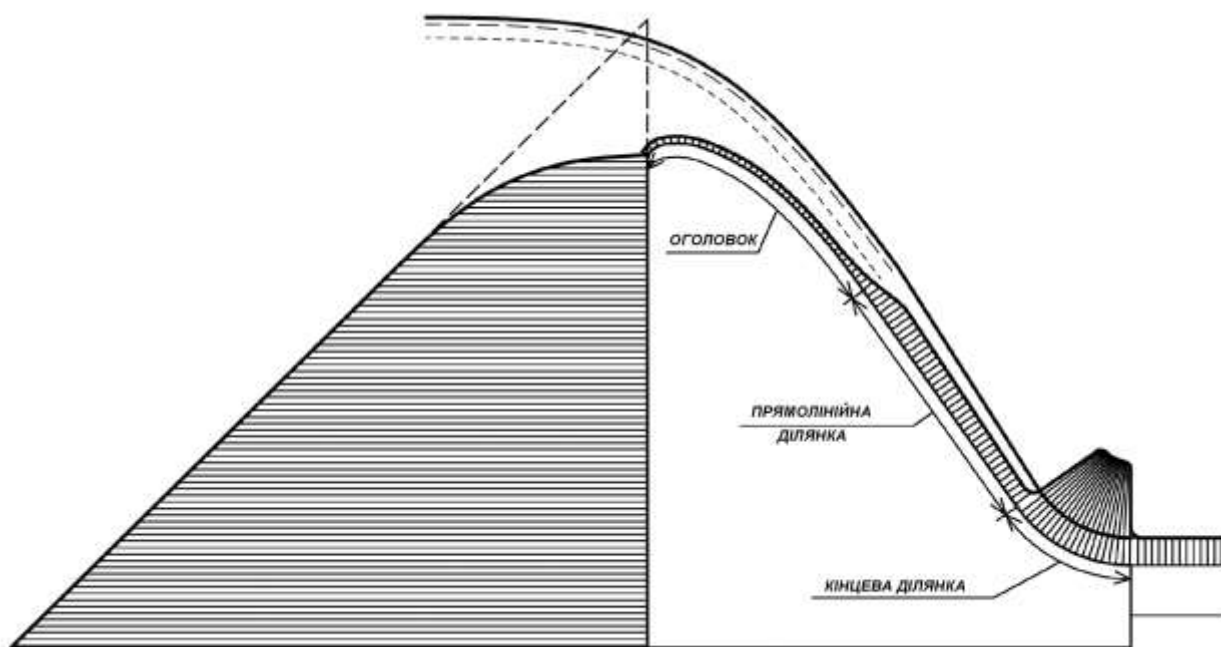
Схема до визначення гідродинамічних навантажень на водозливну греблю
